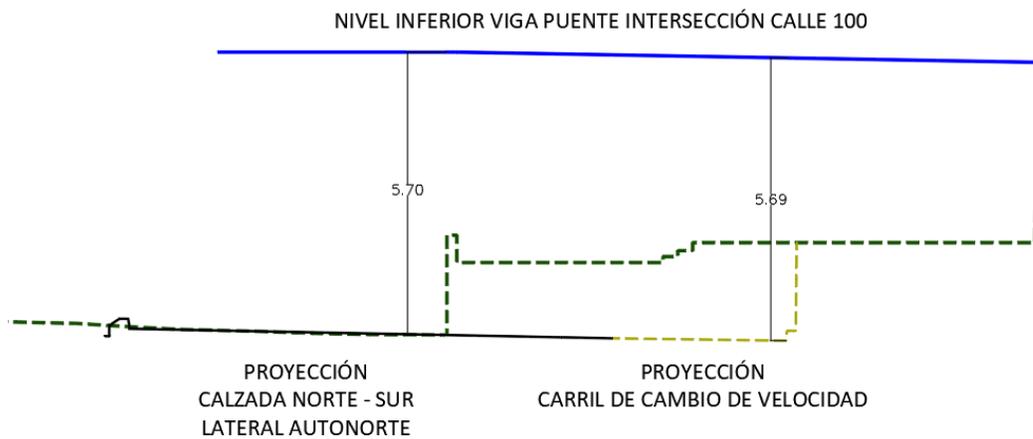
Verificación Gálibo vertical puente existente Autopista Norte con Calle 100
